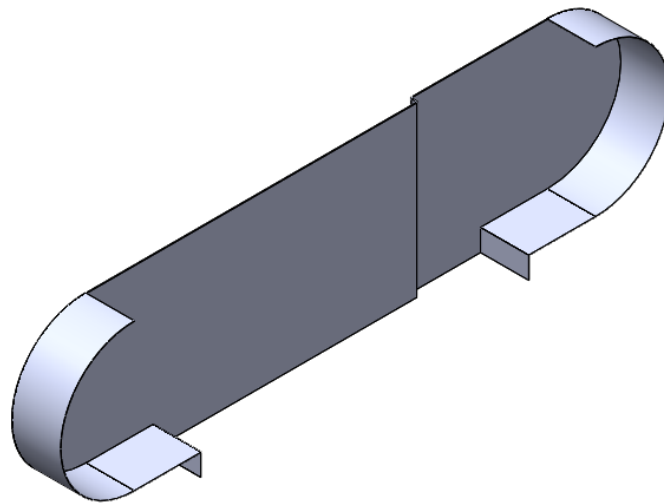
Ensamblaje sistema de encofrado para la segunda etapa de cimentación
